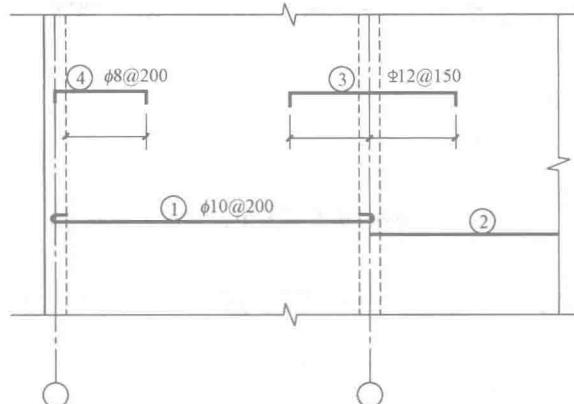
钢筋在楼板配筋图中的表示方法(单位:mm)
